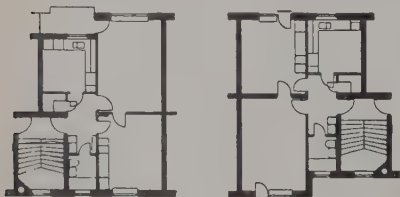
und 24: Typen Grundrisse von Järnbrott (Göteborg-Schweden). Architekten Brodä und Walinder. Diese Grundrisse sind als Serie gedacht, um bei gleichem konstruktiven System und gleichen Abmessungen verschiedene, den Bedürfnissen anpassungsfähige Wohnungen zu erhalten
